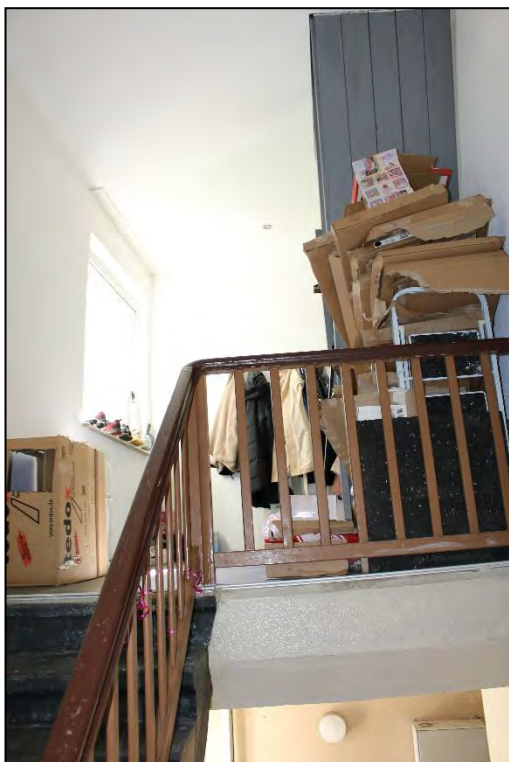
Gemeinschaftstreppehaus, Dachgeschoss
